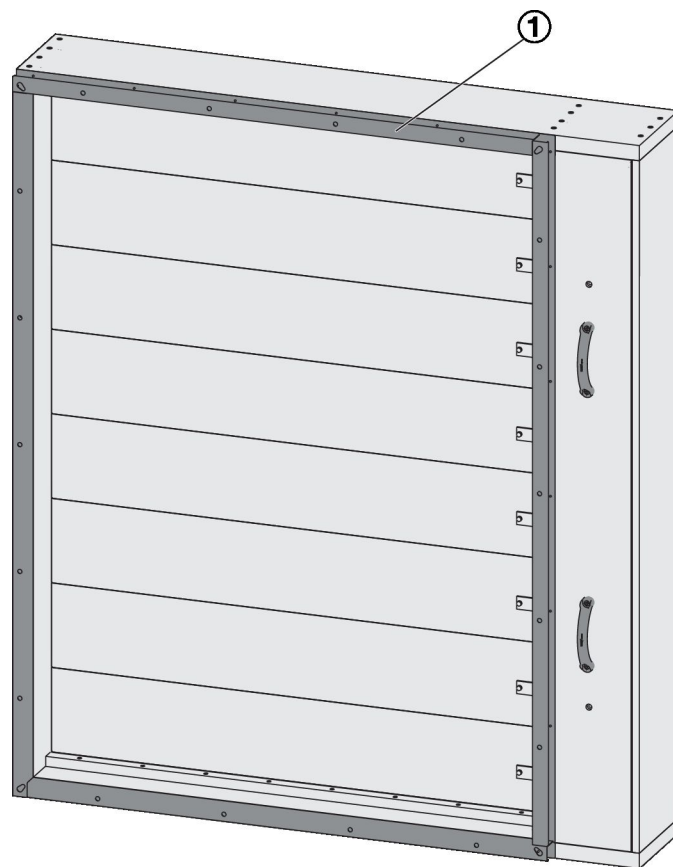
EK-JZ mit Anschlussrahmen für Stahlblech-Entrauchungsleitung
